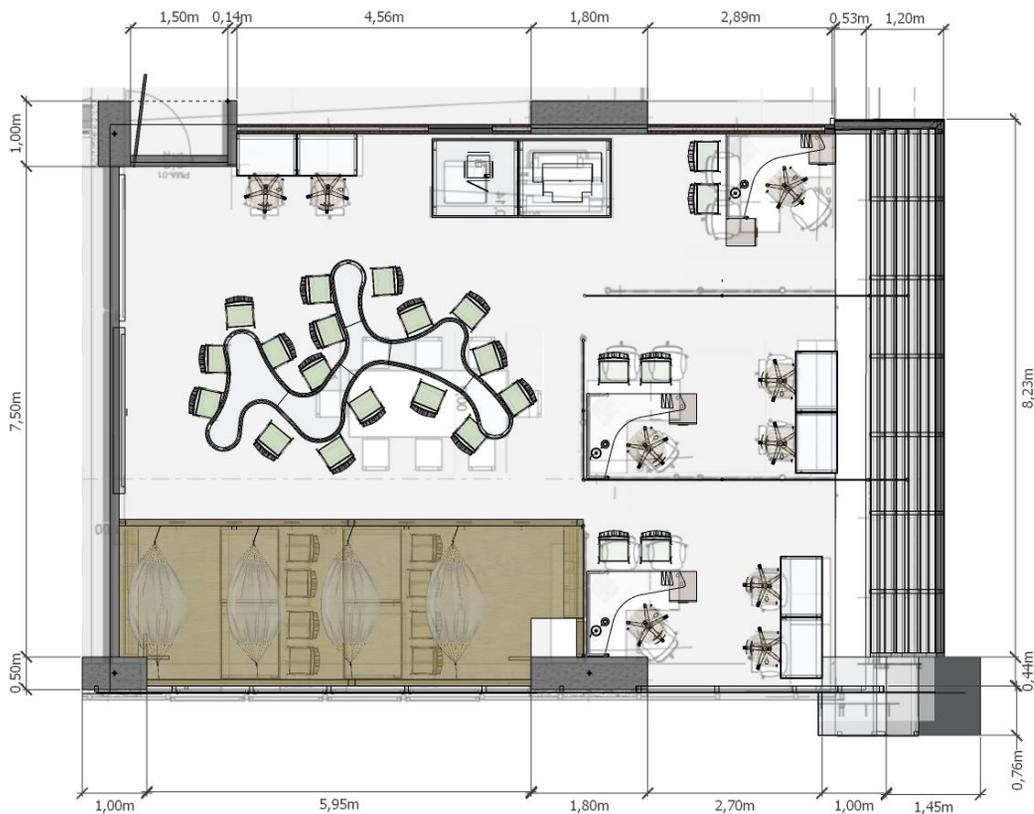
Gómez, C. (2020). Diseño arquitectónico en planta herramienta Sketchup.
